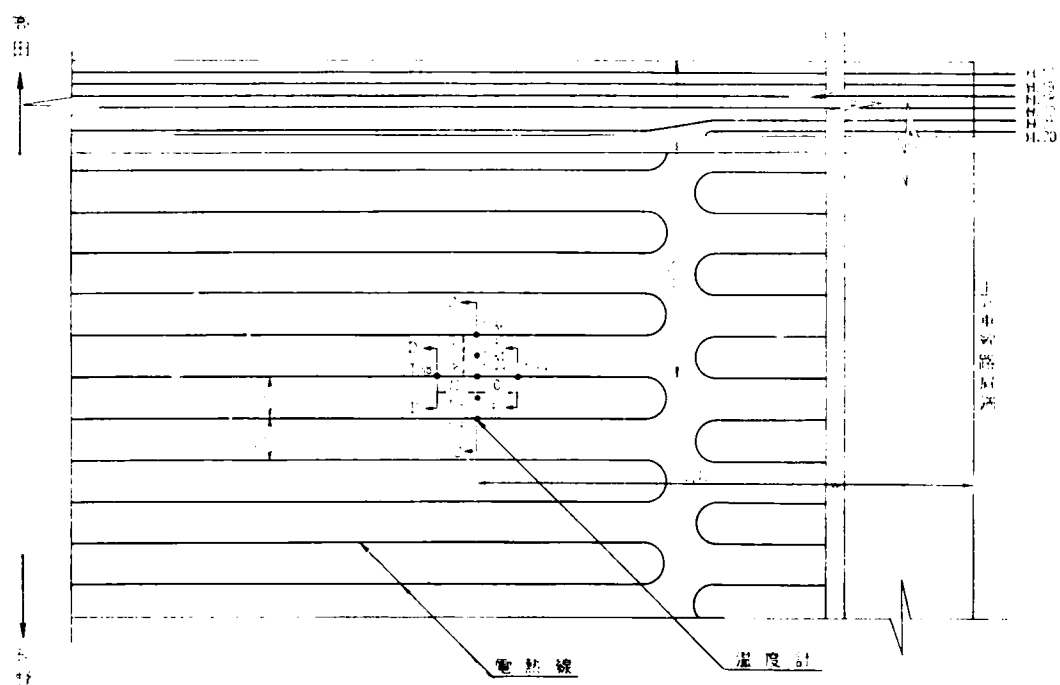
(2) 温度計埋込位置図 c 道路部平面図
